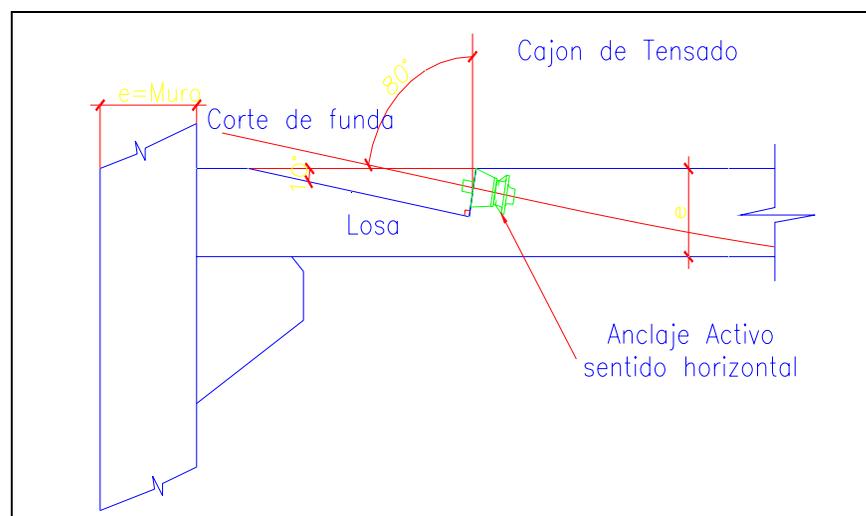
Corte de vaina para ser tensionada, debe quedar no mas de 3cm de cable desnudo en el Moldaje para su posterior hormigonado.
